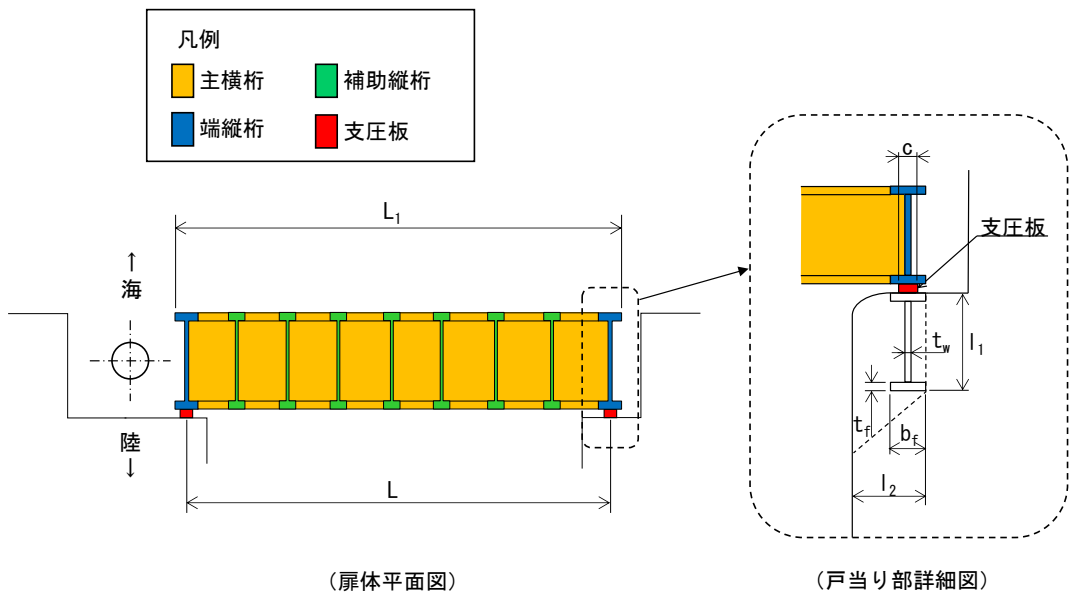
支圧板及び戸当り（腹板，底面フランジ，コンクリート）
